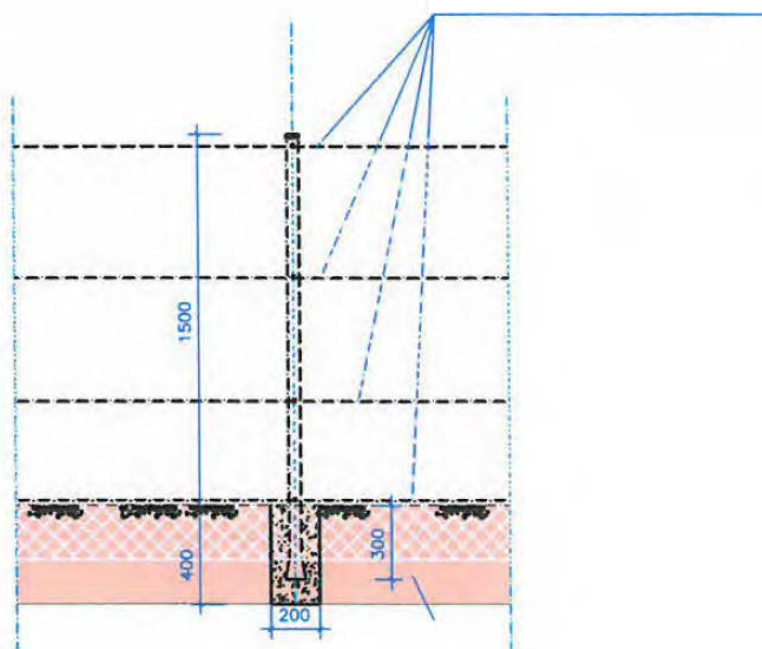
Détail constructive poteau intermédiaire. Cotes en mm.
